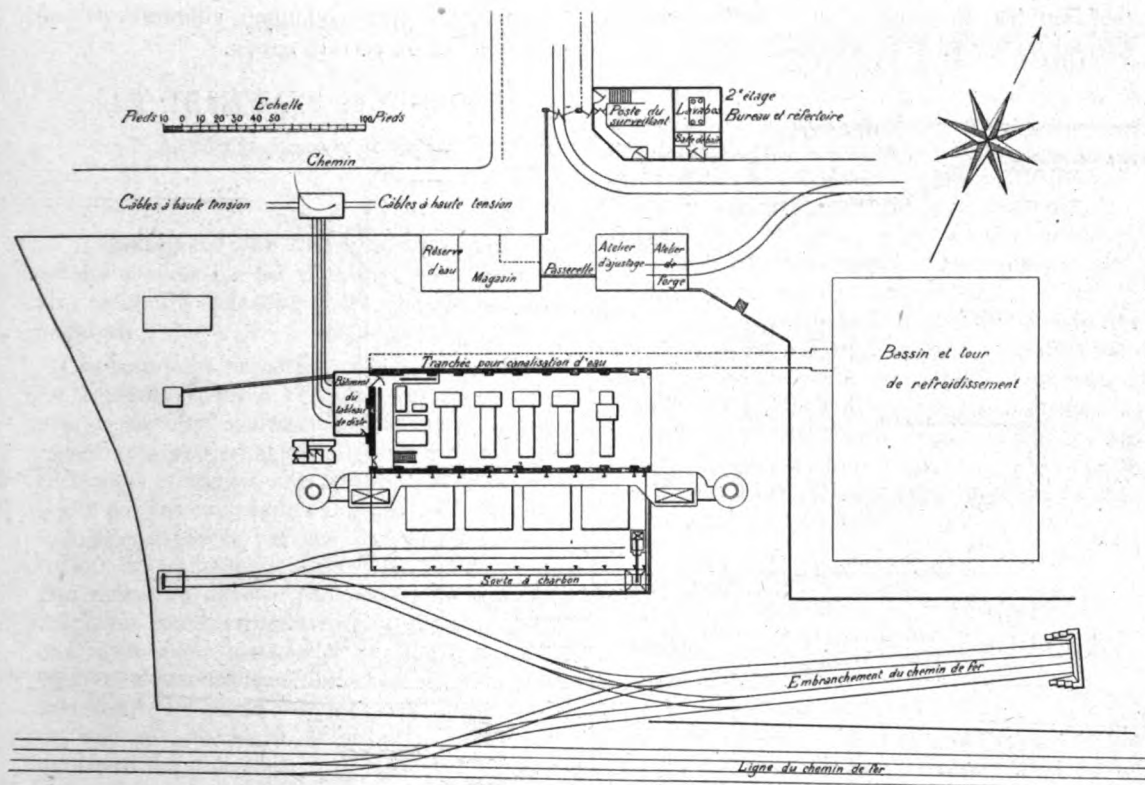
Plan de la station génératrice de Neptune Bank de la C<sup>ie</sup> Newcastle Upon Tyne Electric Supply.
